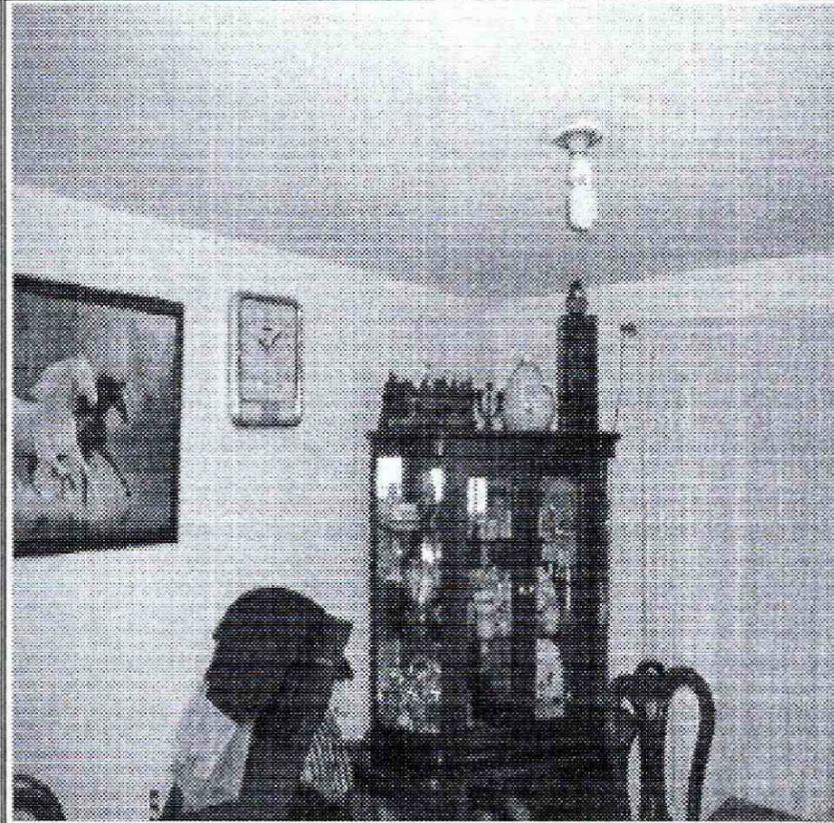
Vista interior predio de la Diagonal 68 I Sur No. 22 B - 21
